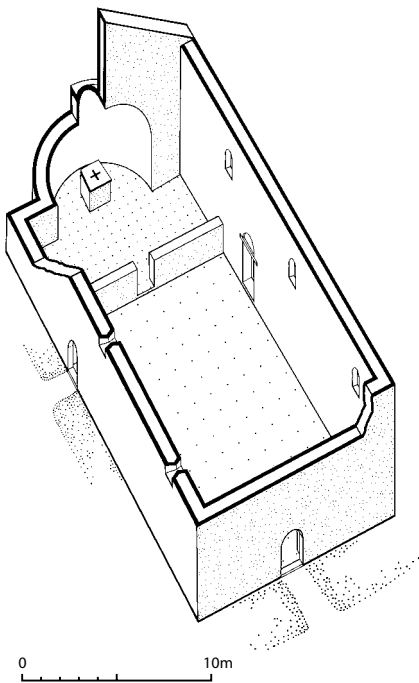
, oben: Worb, Kirche. Frühromanische Kirche. Grundriss. M. 1:400.
